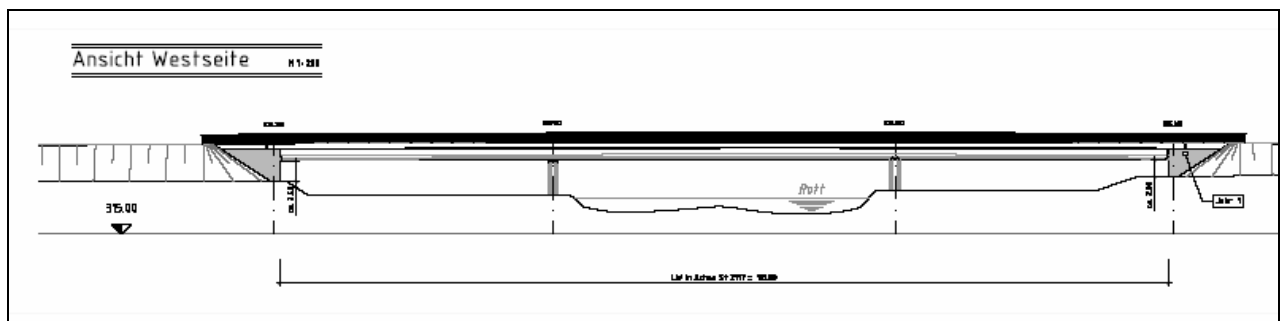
Ansicht der neuen Rottbrücke (3-Feld) im Zuge der St2117
